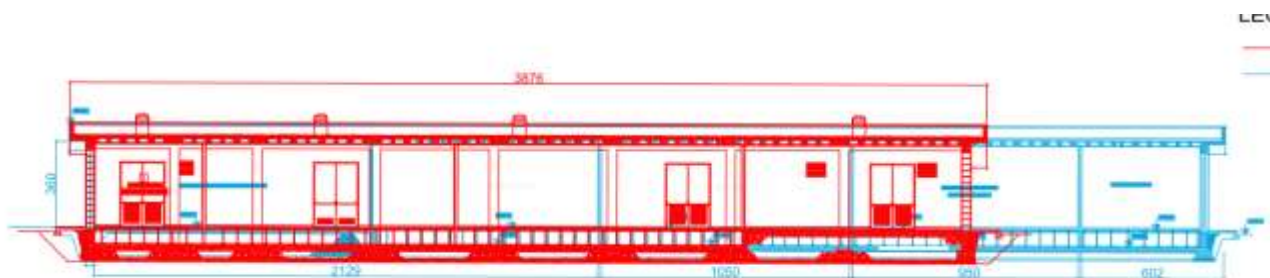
Sezione longitudinale del fabbricato FA1H nel Progetto approvato (in blu) e nel Progetto di variante (in rosso)
